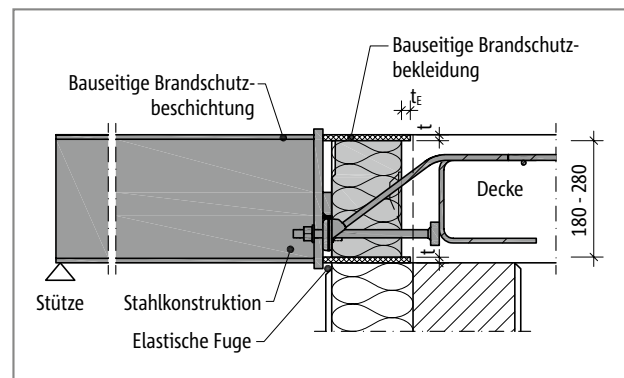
Schöck Isokorb® XT Typ SQ: Bauseitige Brandschutzbekleidung für den Isokorb®, brandschutzbeschichtete Stahlkonstruktion; Schnitt
